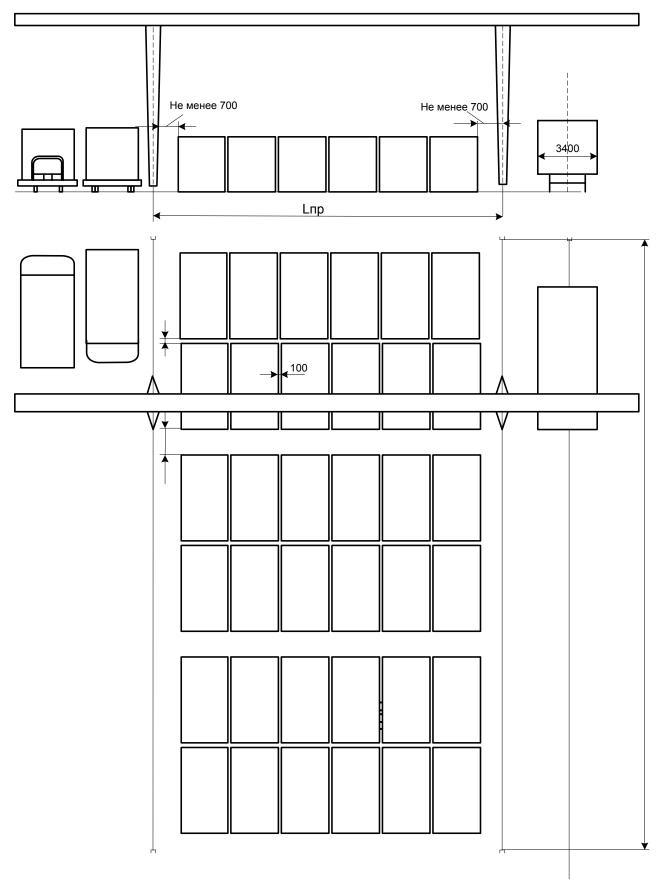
Поперечный разрез и план контейнерной площадки для крупнотоннажных контейнеров
